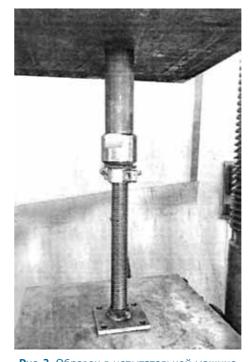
Образец в испытательной машине Fig. 2. The sample is in the testing machine
